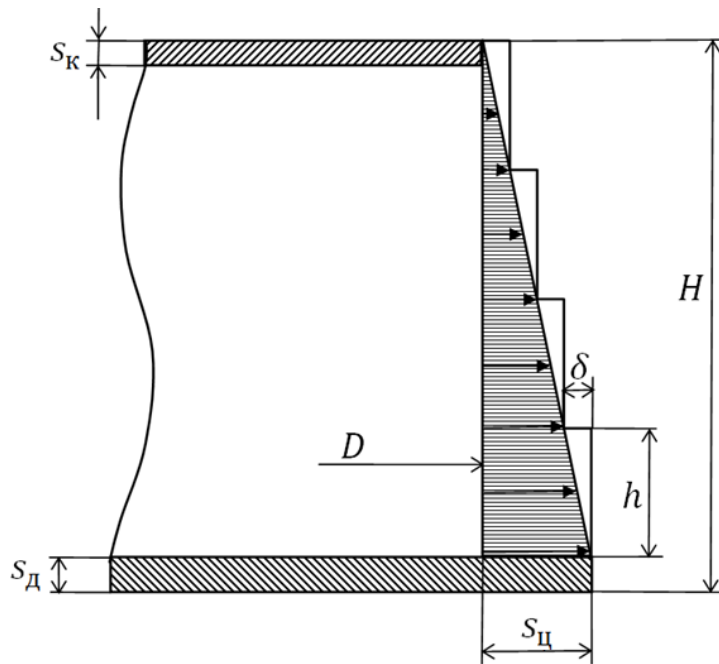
Схема для расчета оптимальных размеров цилиндрического резервуара
